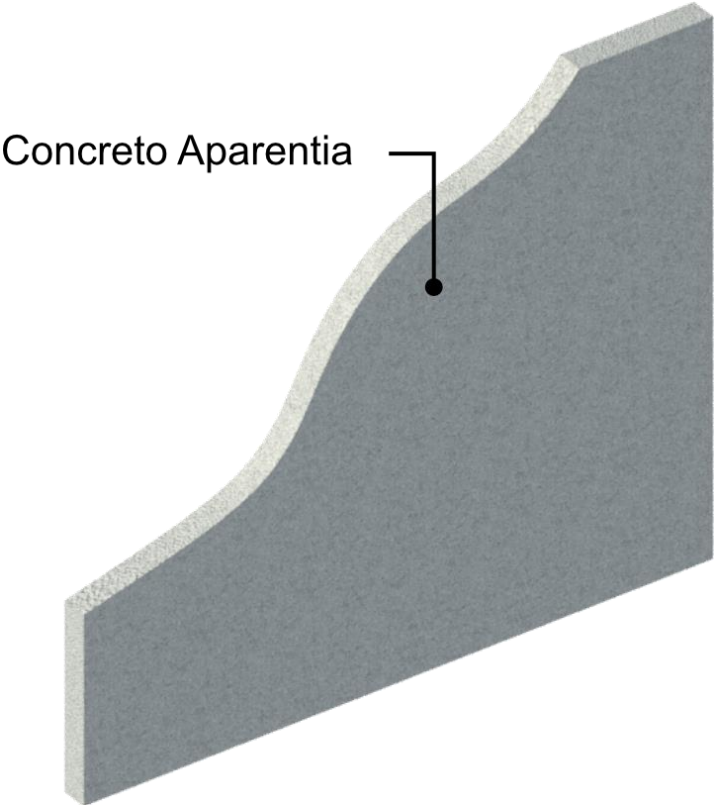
Detalle constructivo de muro de concreto aparentia. Elaboración propia.
